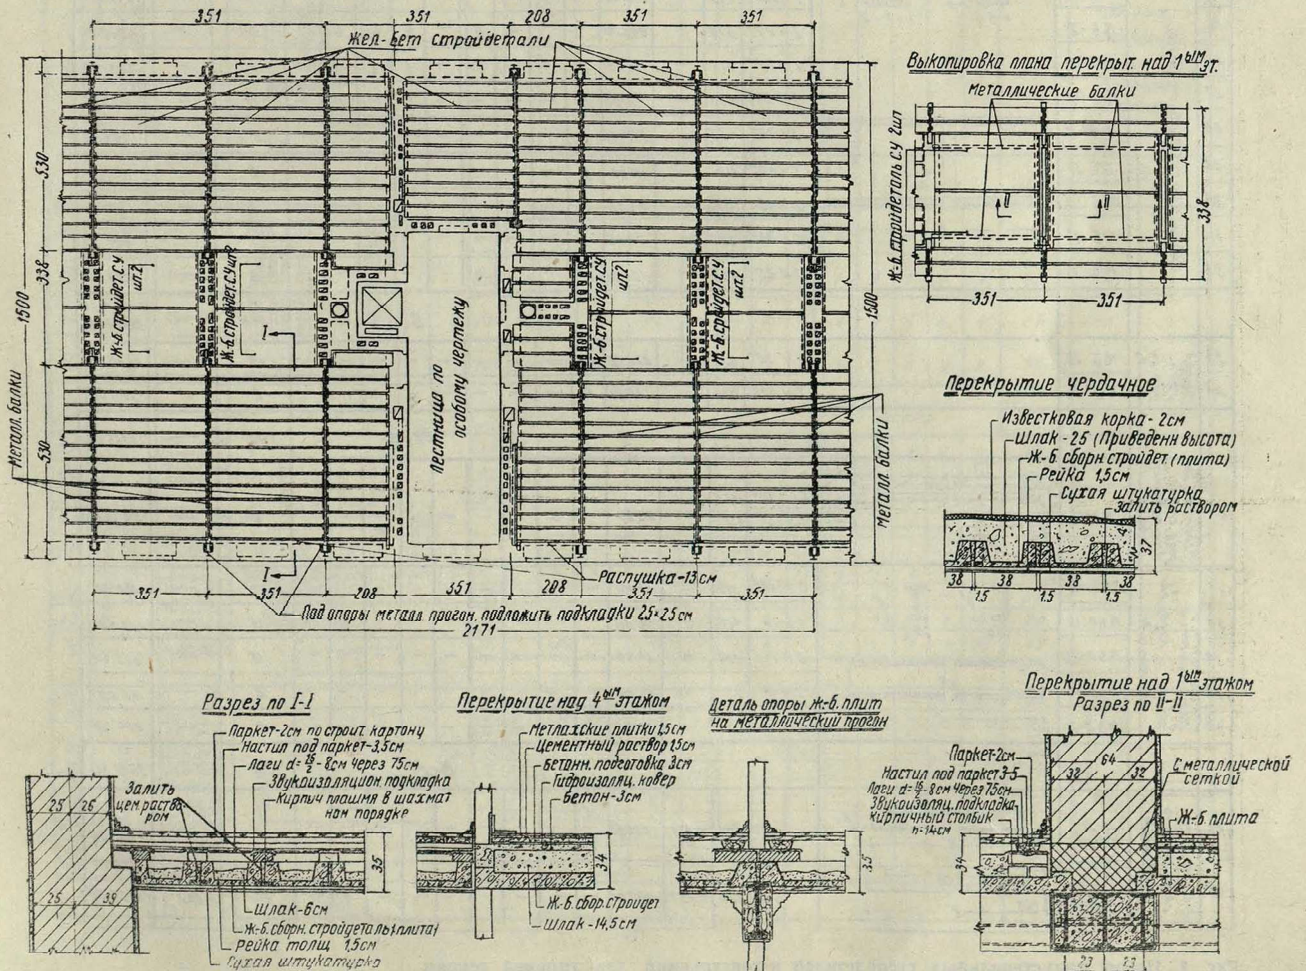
План и разрезы перекрытия из сборных железобетонных элементов по металлическим балкам.
